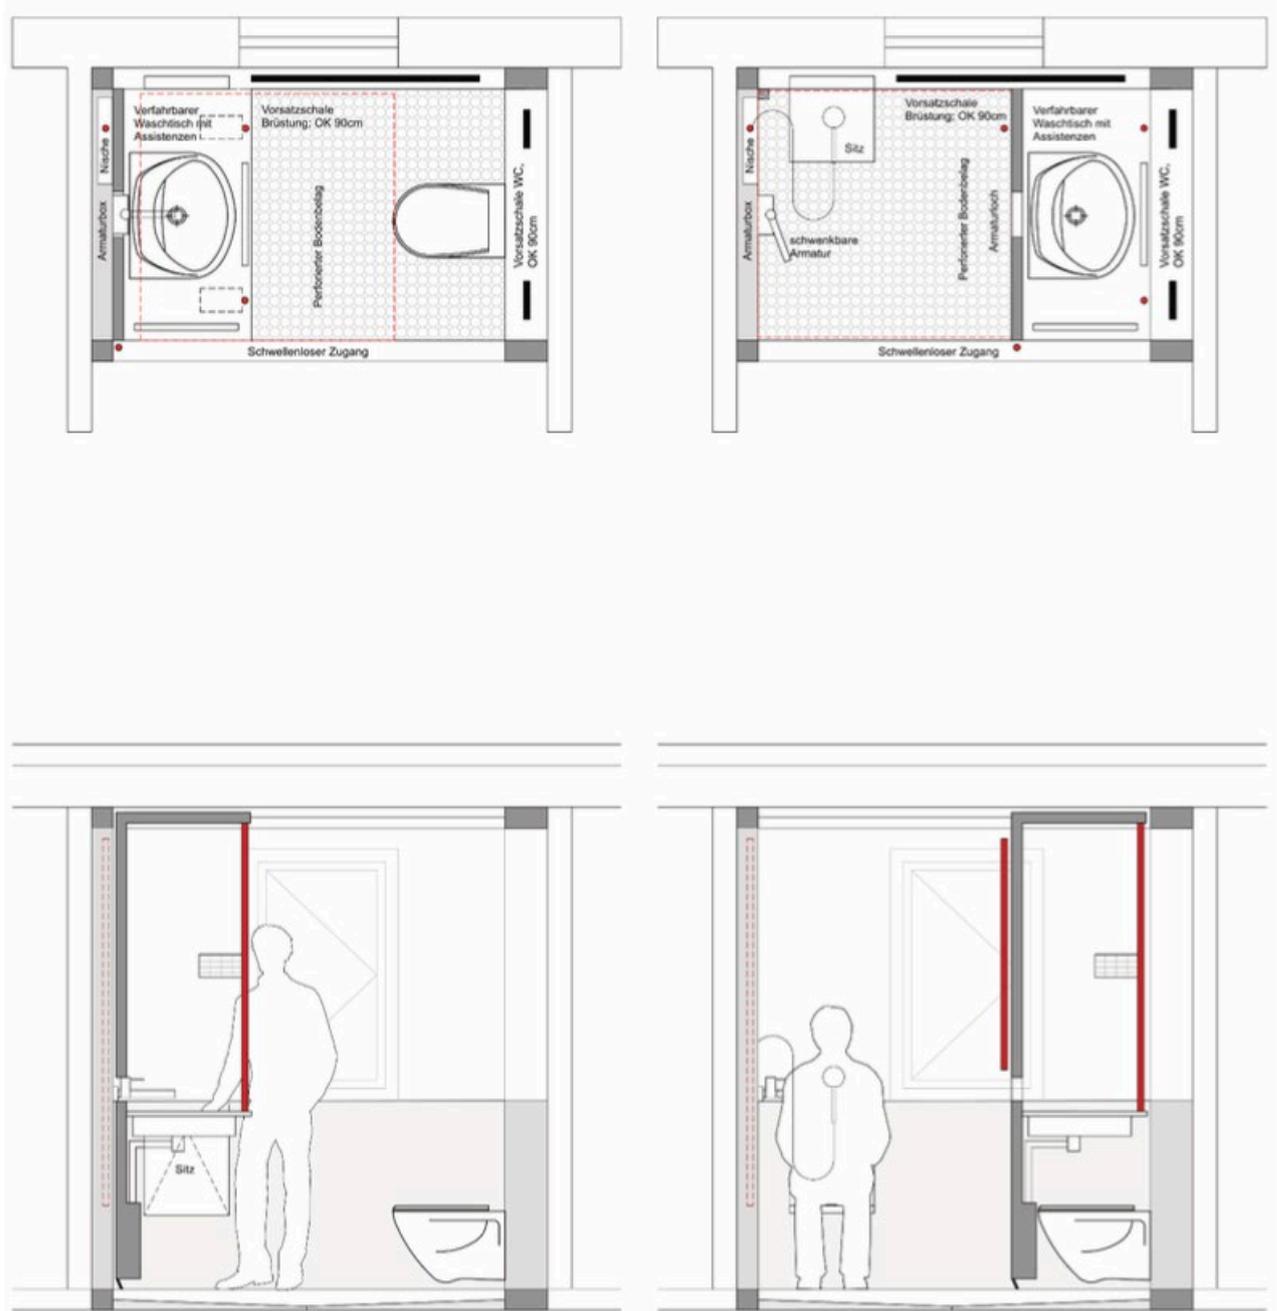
Grundriss und Schnitt; Position Waschtisch und Dusche barrierefrei
